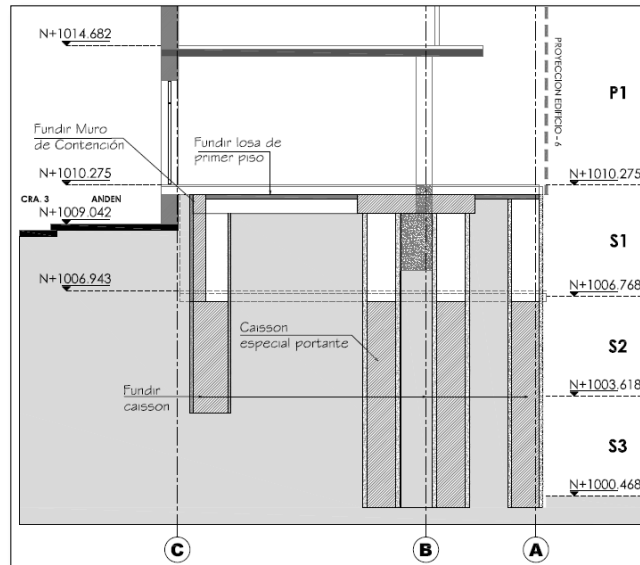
Sección Paso No. 3 Alternativa 1 –Caissons y losa de primer piso.
